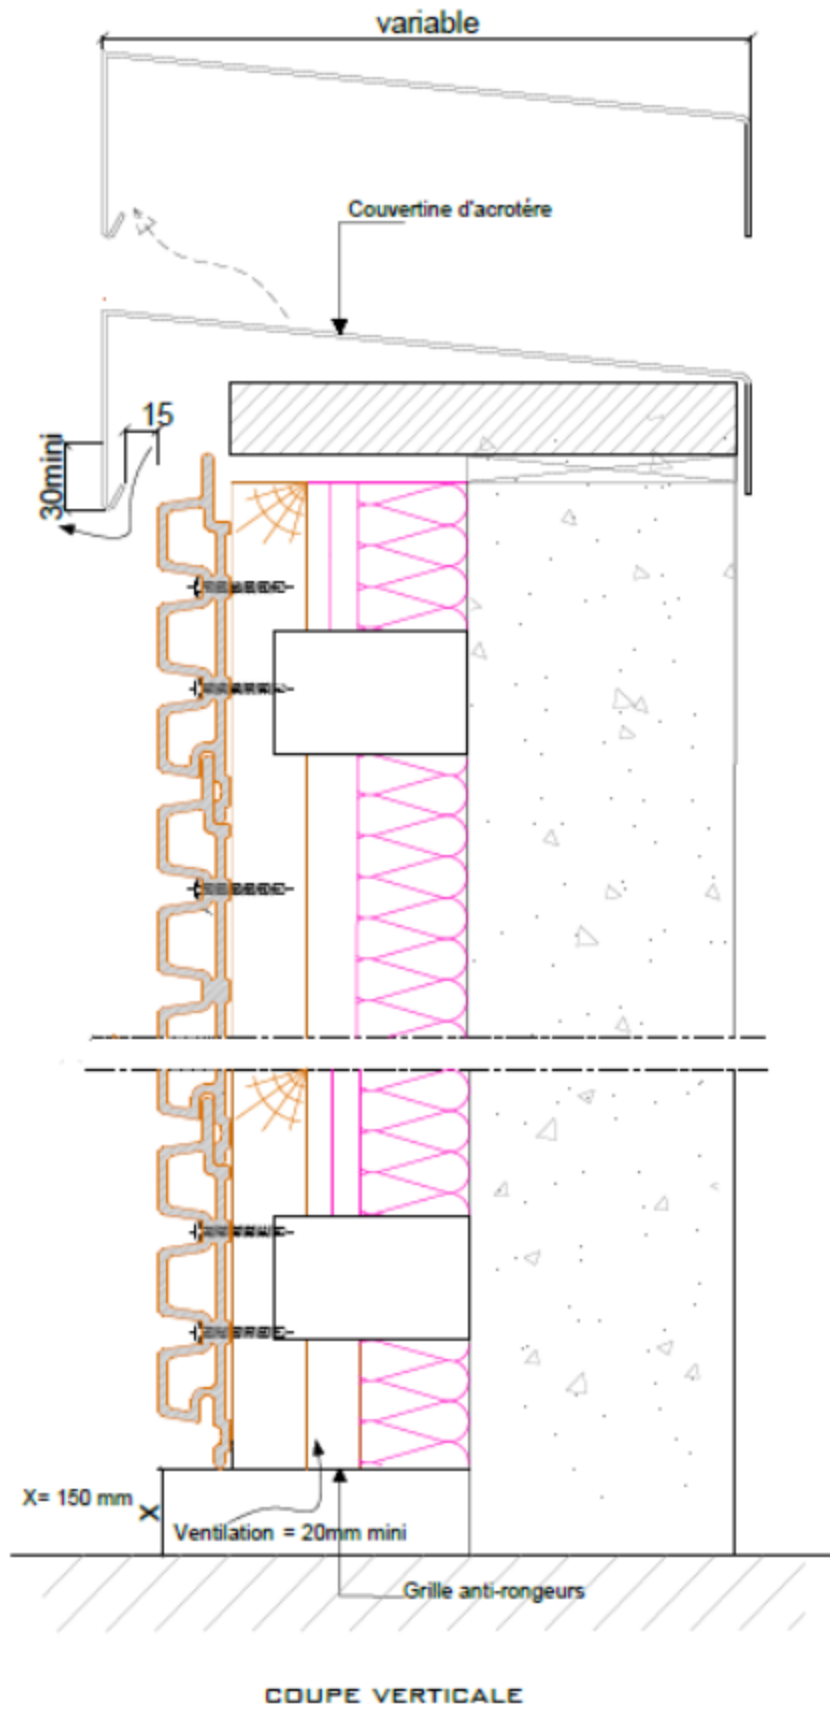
Coupe verticale : départ et arrêt haut bardage sur ossature bois en pose horizontale
